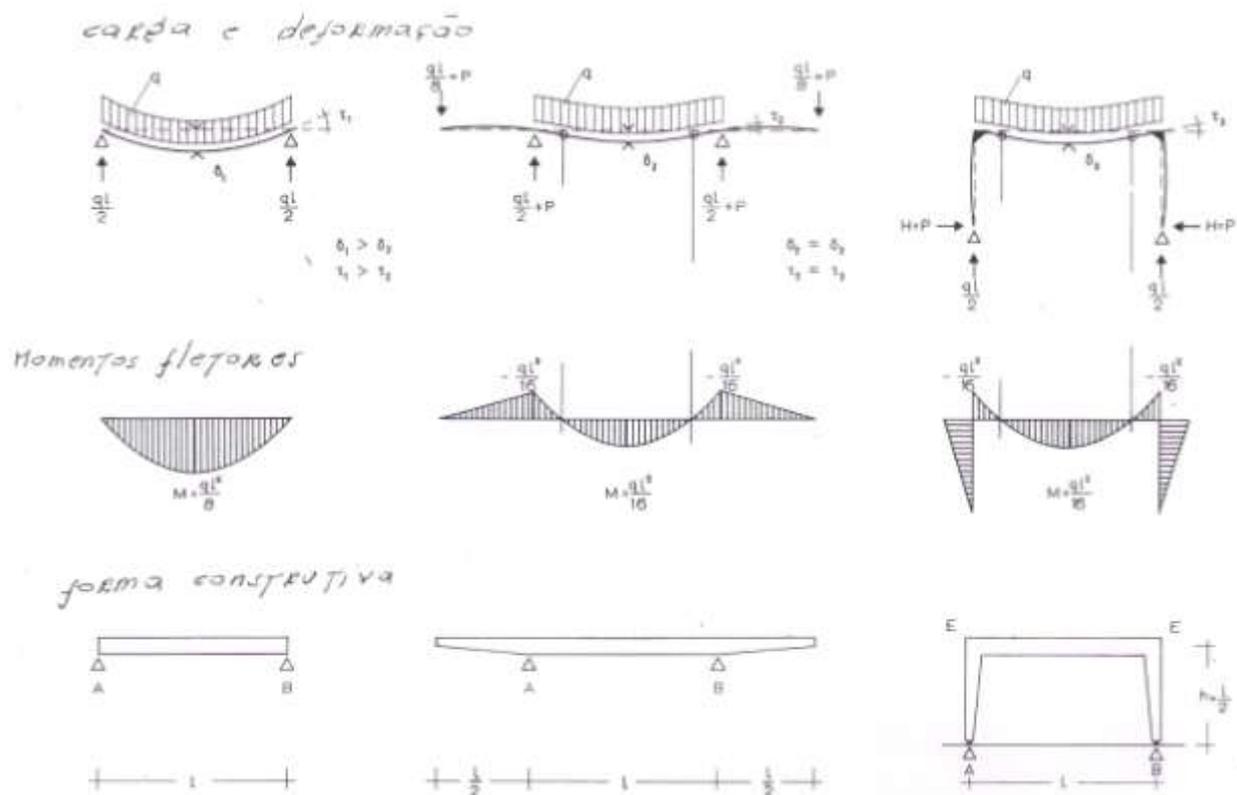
A relação de semelhança entre vigas e pórticos. 1) Coluna 1: deformação e momentos de uma viga apoiada sobre dois pontos; 2) Coluna 2: ao se carregar com balanços, se alivia a carga sobre a viga para os apoios; 3) Coluna 3: os pilares do pórtico aliviam a carga da trave por pelo impedimento de deslocamento. Fonte: (SIEGEL, 1966). Manuscrito: Prof. Ernesto Walter.
